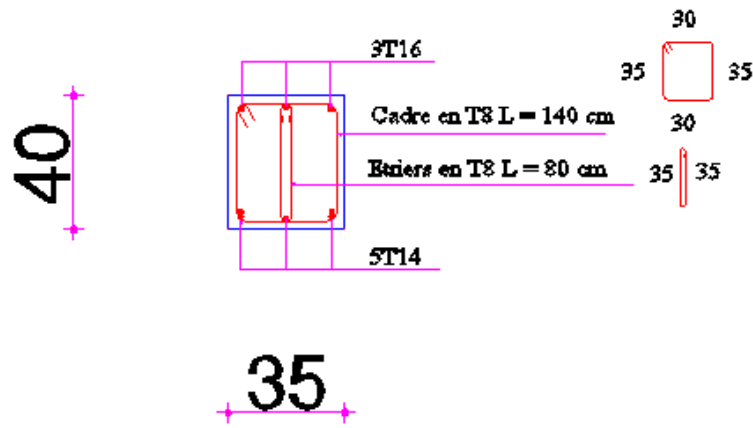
ferrailages des poutres principales en travée (35x40)
